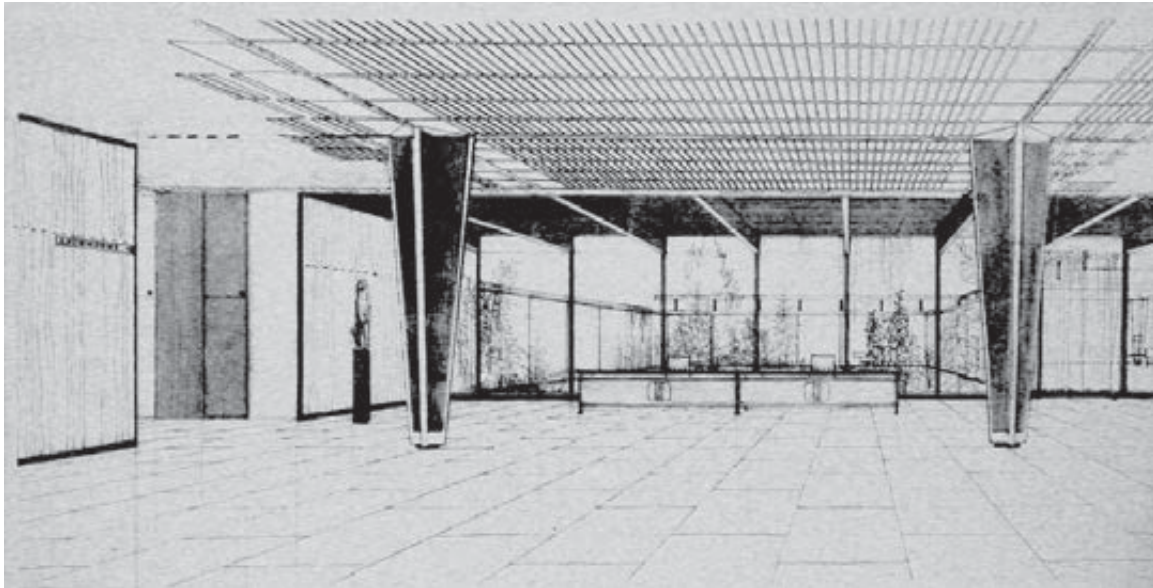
Disegno prospettico dell'ingresso (AB)
